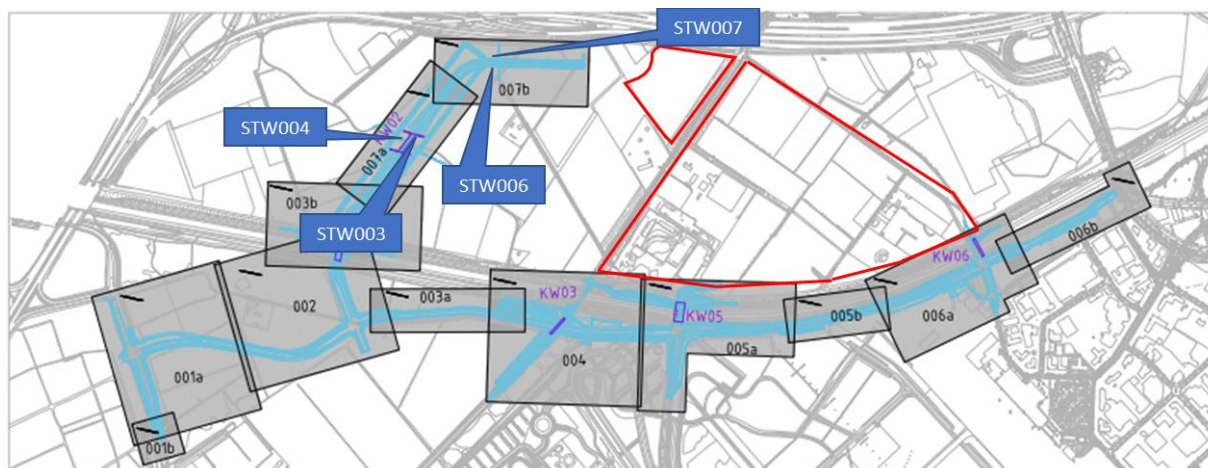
Uitvoeringsontwerp wegenstructuur Eindhoven-Noordwest – Ondergaan A2/N2 (tekening nummer 3523-0352-03564-1)
